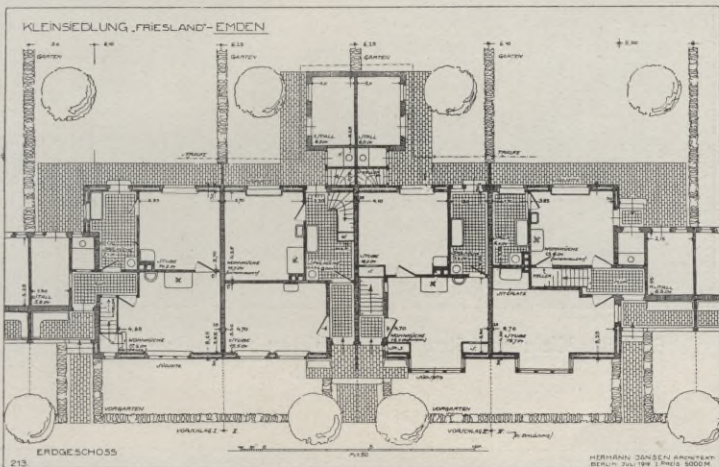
Kleinsiedlung „Friesland“-Emden. Grundrissotypen.
